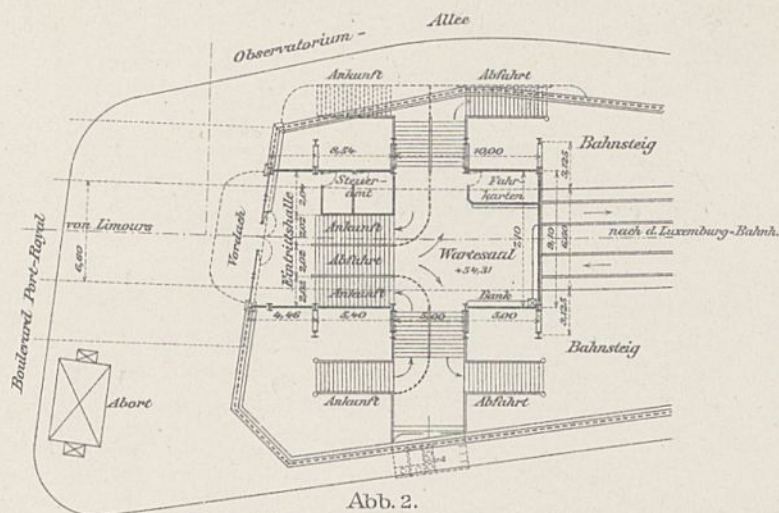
Grundriss der Port-Royal-Station. 1:500.
